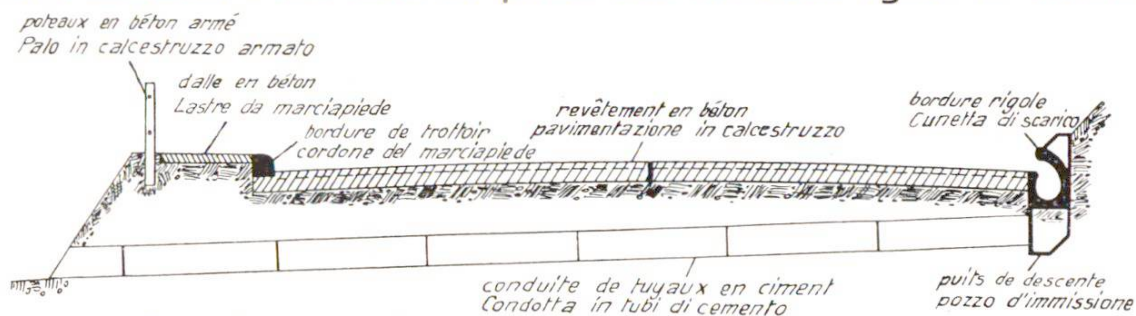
Route en béton munie de produits modernes en ciment.
